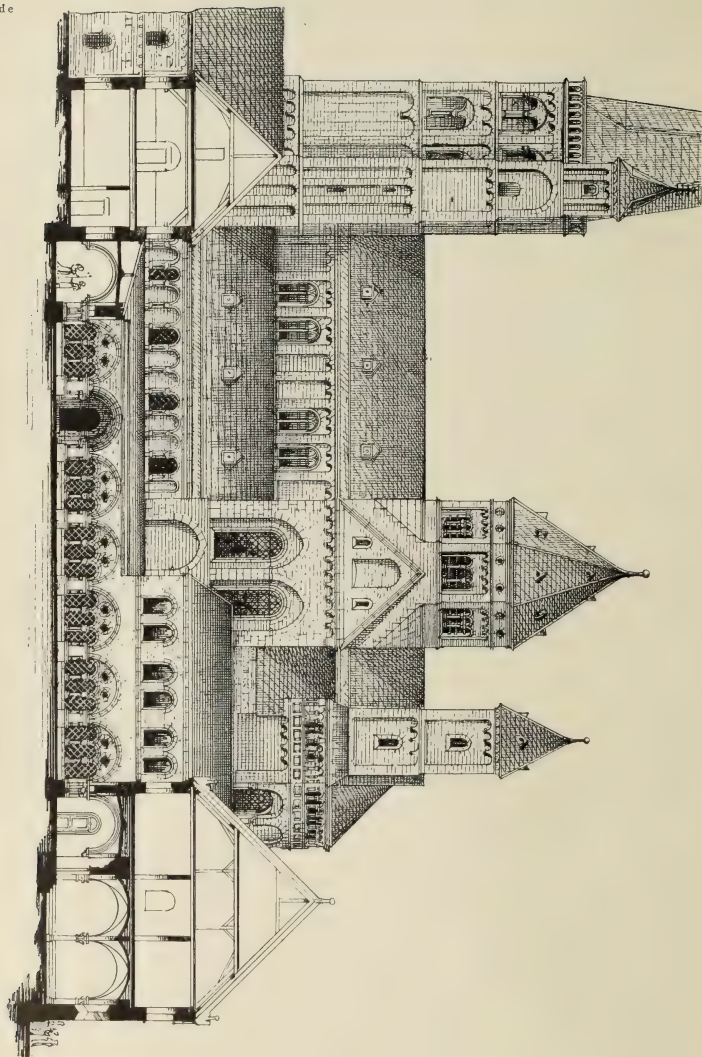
Braunweiler. Rekonstruierte Sudansicht der Kirche mit dem Abteigebäude.
